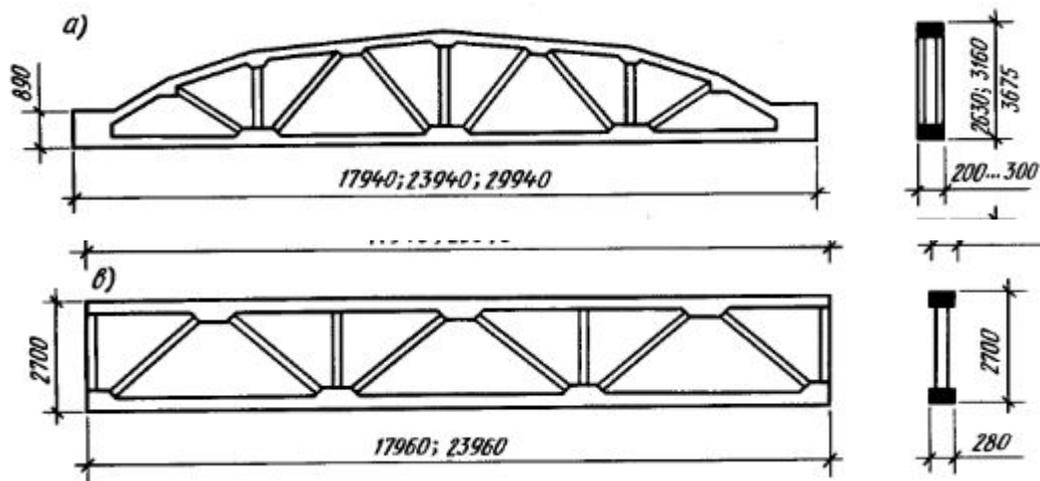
(а)- Унифицированные сборные железобетонные фермы
